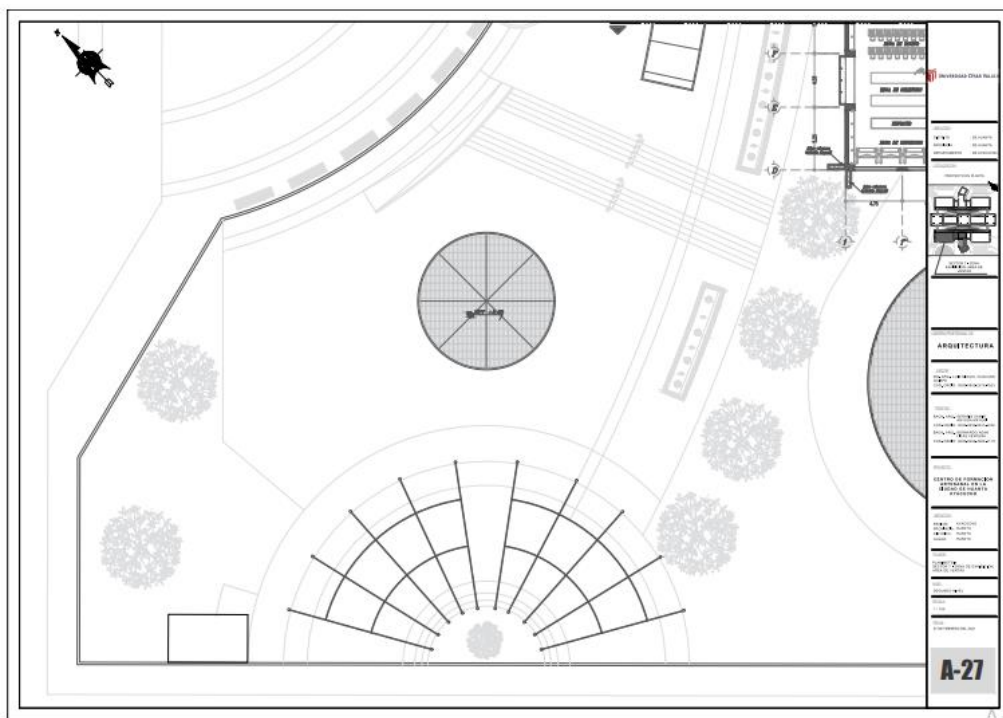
Planimetría de techos del sector 7. Escala 1/100.
